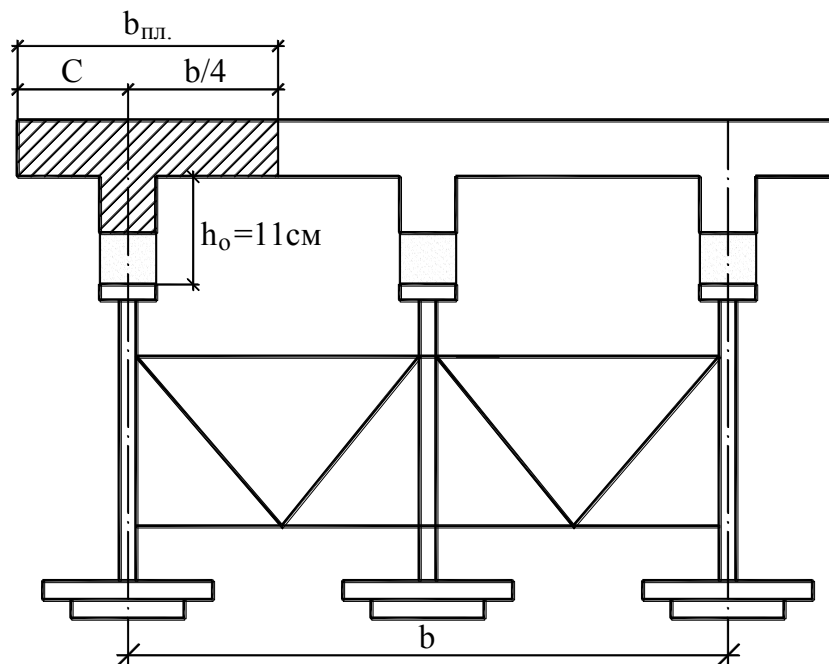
Схематический поперечный разрез сталежелезобетонного пролетного строения для габарита Г-11,5 м
